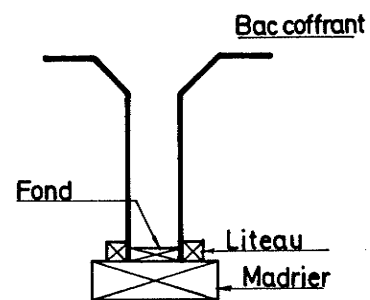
Fixation du coffrage en pied pour réaliser la nervure.
